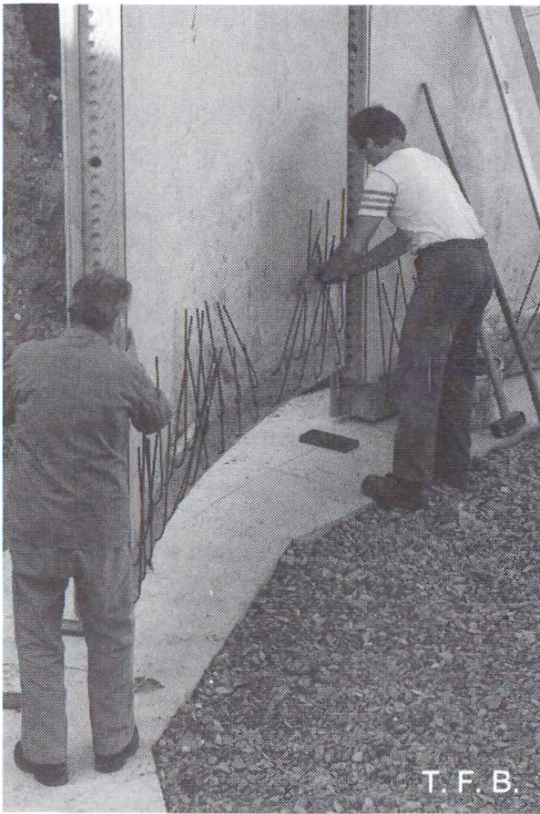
Réservoir à purin en éléments de béton. Montage sur des poutres de montage posées au préalable. Couche de grave comme fondation de la dalle de fond.
